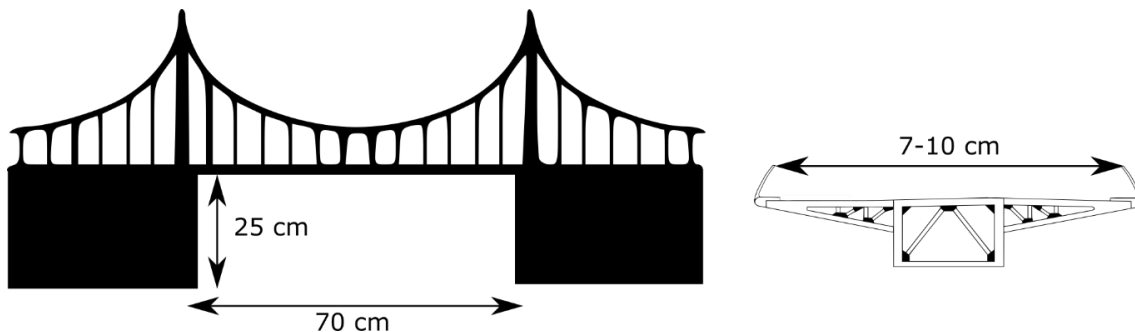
Dimensiones mínimas de la maqueta a construir. [Elaboración propia].
